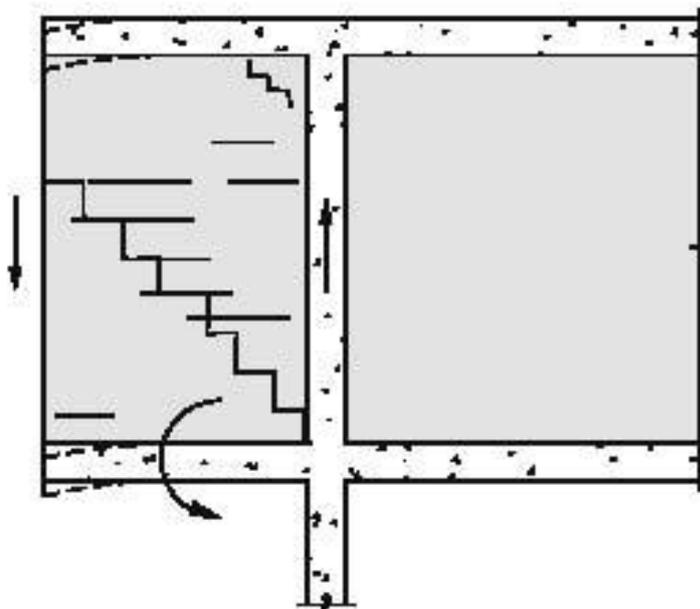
Flexão de vigas em balanço causando fissuras
